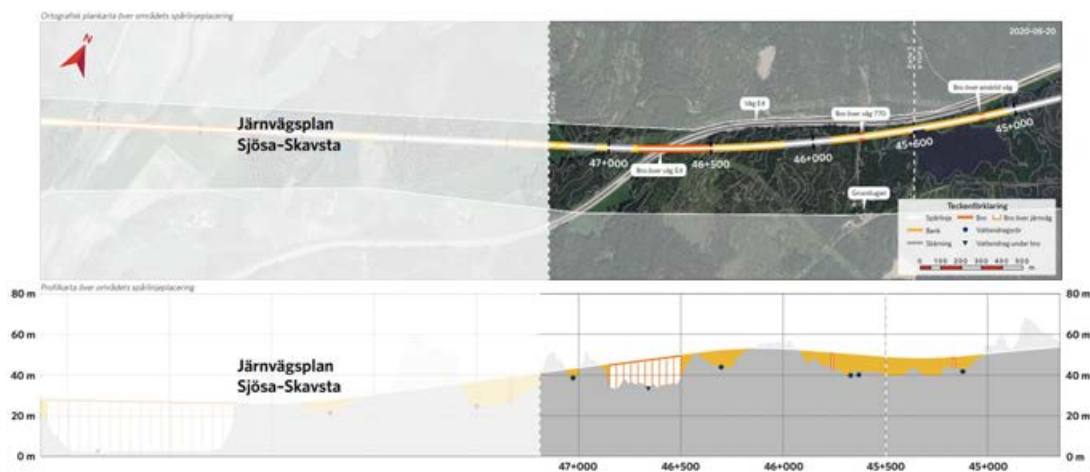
Järnvägens sträckning i plan och profil förbi Tystberga.
